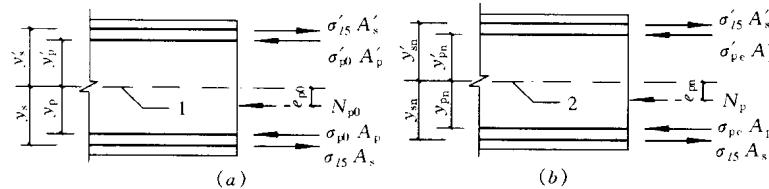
预应力钢筋及非预应力钢筋合力位置
